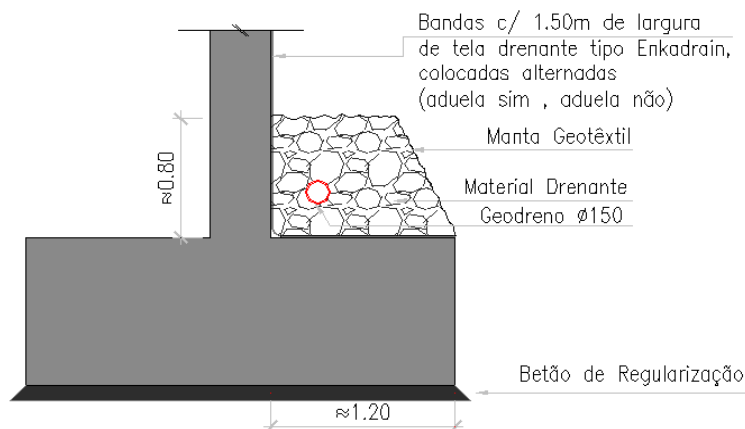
Pormenor do sistema de drenagem junto à sapata da parede lateral (COBA *et al.*, 2008)
